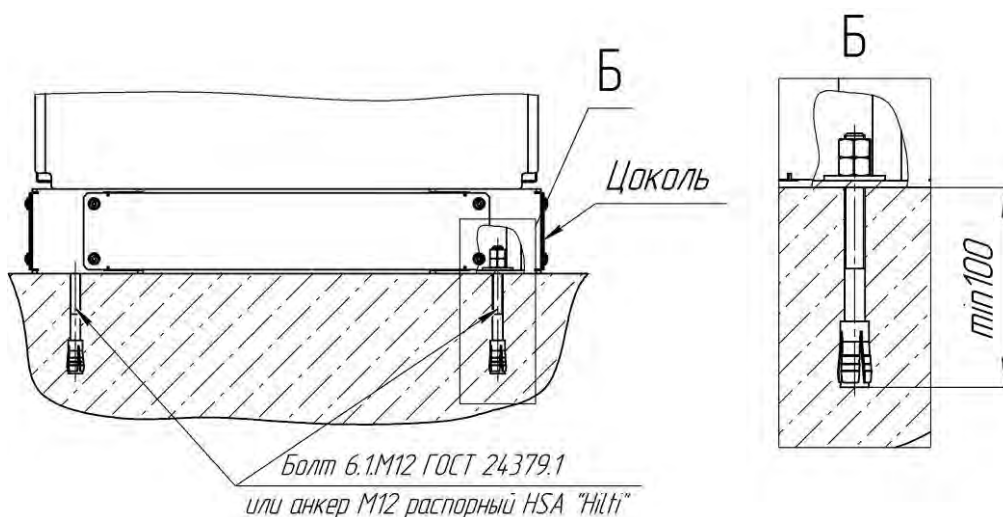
Вариант крепления ШРОТ с помощью анкерных болтов
